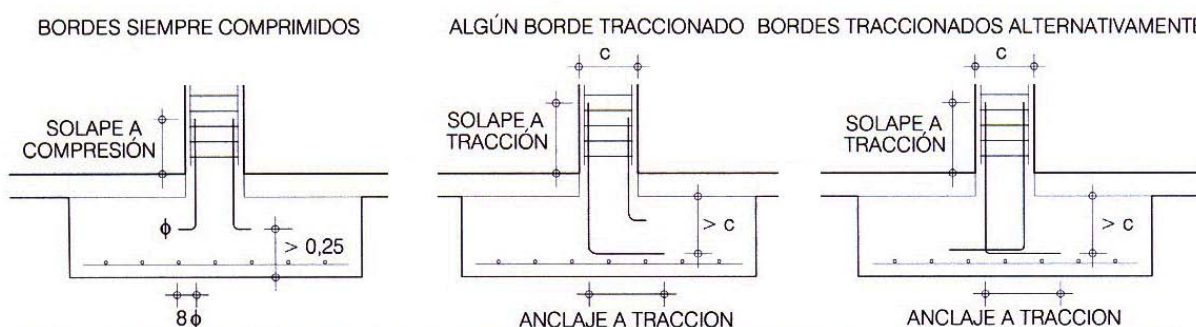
Esperas de soporte de hormigón en zapata armada (según NCSE-02)
